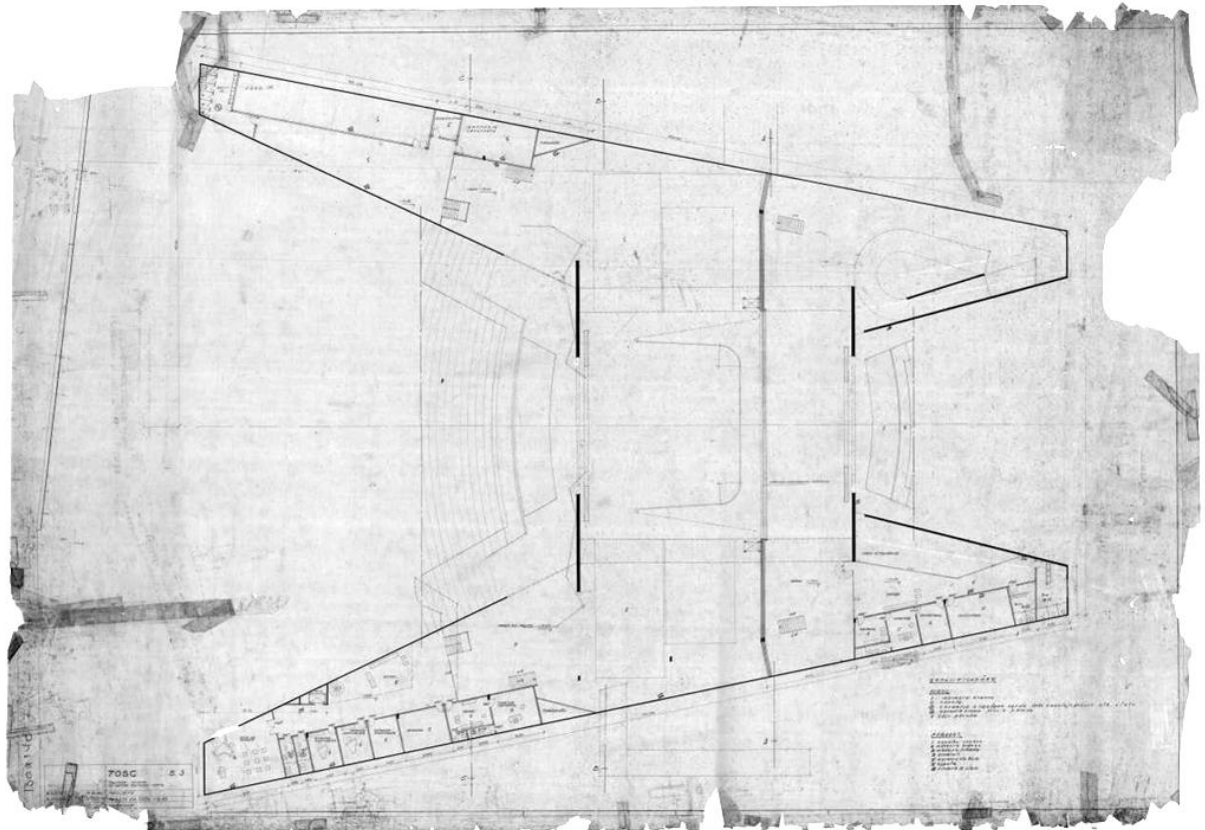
Planta Baixa - Subsolo 2 (1960). Carimbo: Teatros Oficiais no Setor Cultural Norte, TOSC, 5.3. Conteúdo: Planta da cota -6,40. Data: 09/03/1960. Fonte: ARPDF.
